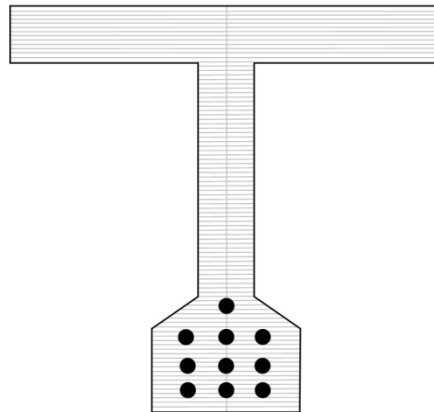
Discrétisation de la section de la poutre pour le calcul de flexion longitudinale
